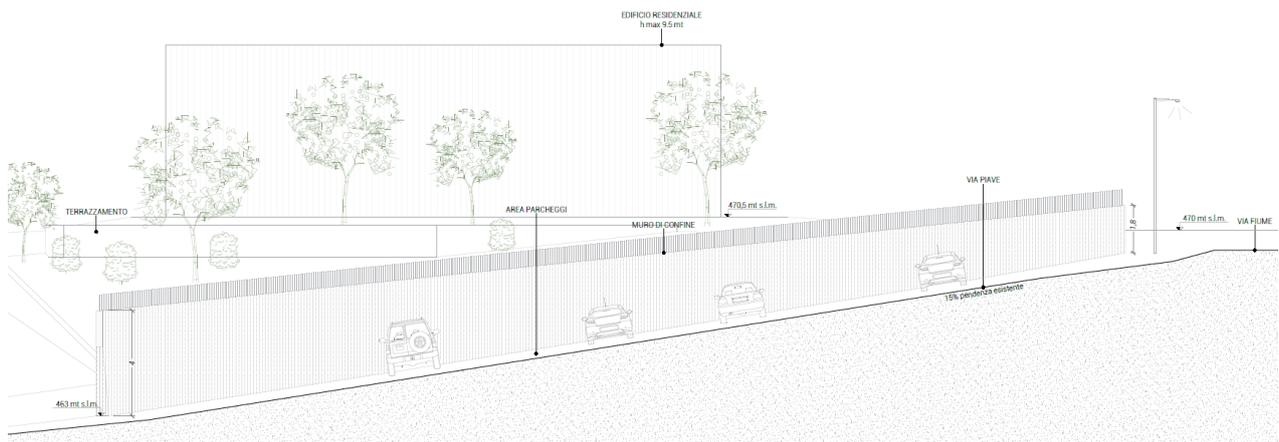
Estratto da All. EA_c_03_R2 Stato di progetto
